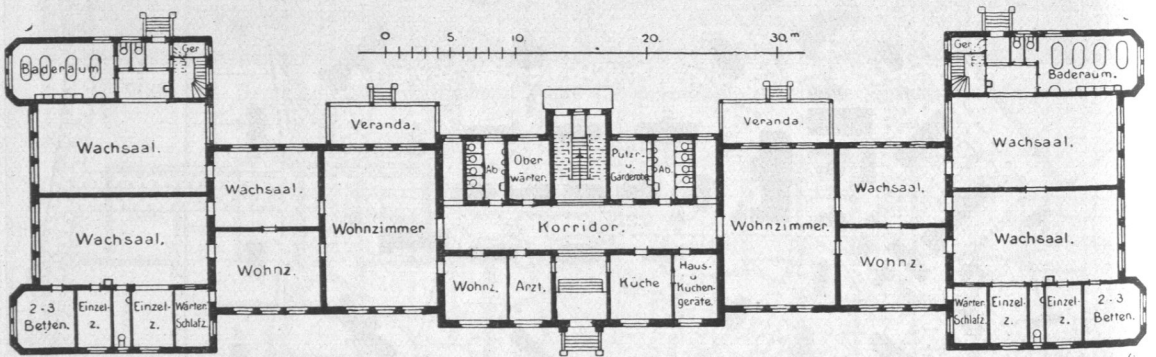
Irrenanstalt Langenhorn, Pflegehaus für 150 Männer und 18 Wärter, Erdgeschoß, Grundriß.
